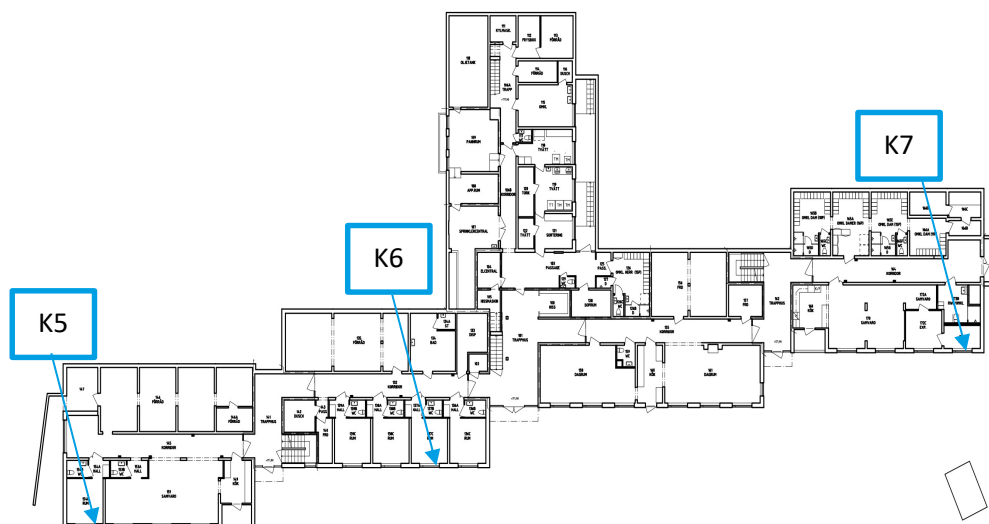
Placering av konstruktionsingrepp i utfackningspartier under fönster i ytterväggar.
